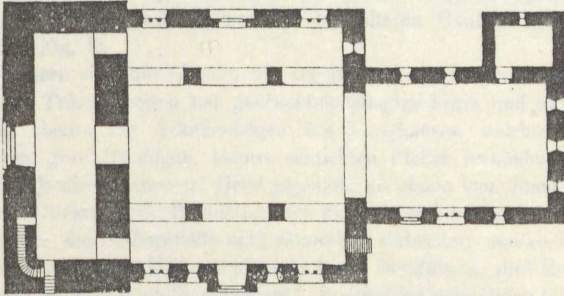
Bahn; Kirche, Grundriss vor dem Umbau von 1854.
